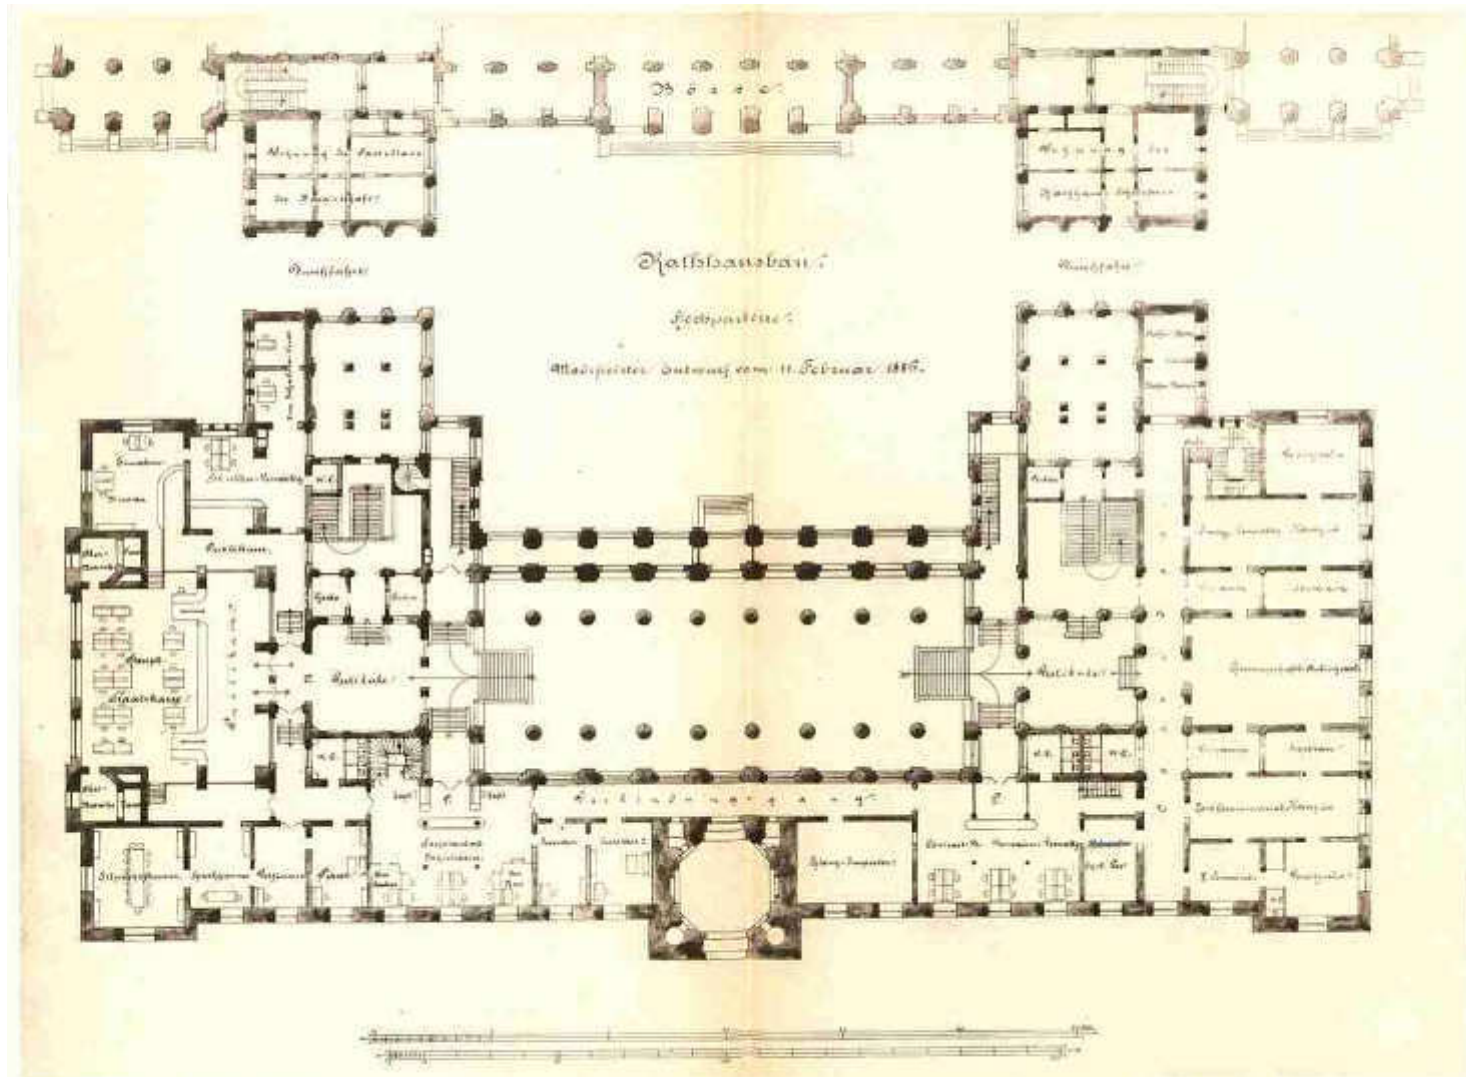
Rathausbau Grundriss Hochparterre 11. Februar 1886 mit neuer Achsenzahl.
